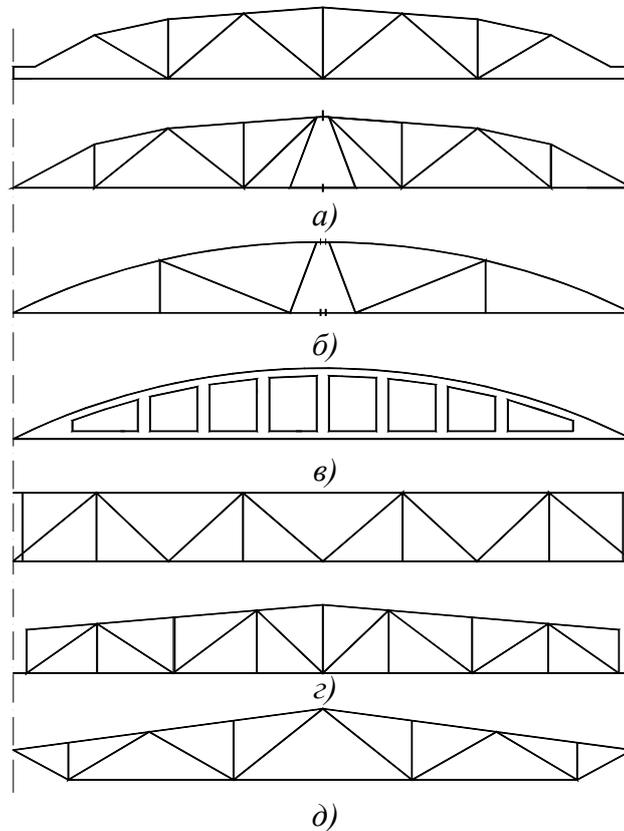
Фермы покрытий: а – сегментные с верхним поясом ломаного очертания; б – арочные раскосные с редкой решеткой и верхним поясом криволинейного очертания; в – арочные безраскосные с жесткими узлами; г – полигональные с параллельными поясами или трапецевидные; д – полигональные с ломаным нижним поясом
